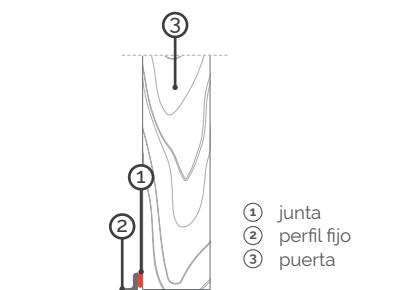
Junta elástica horizontal sujetada a un perfil fijo al pavimento
